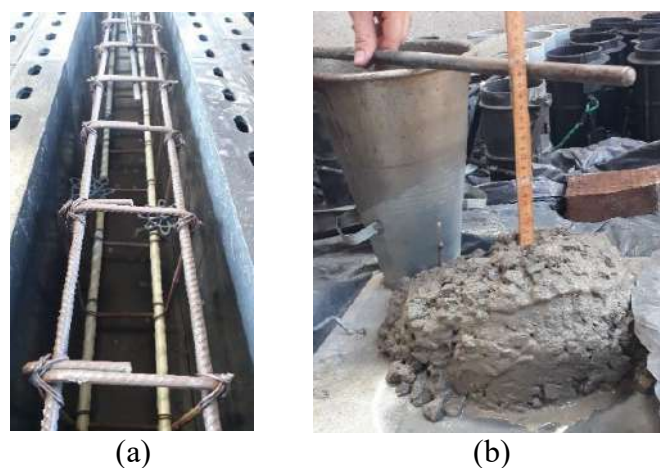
Posicionamento da armadura na fôrma (a) e ensaio de abatimento de tronco de cone no concreto fresco (b).
